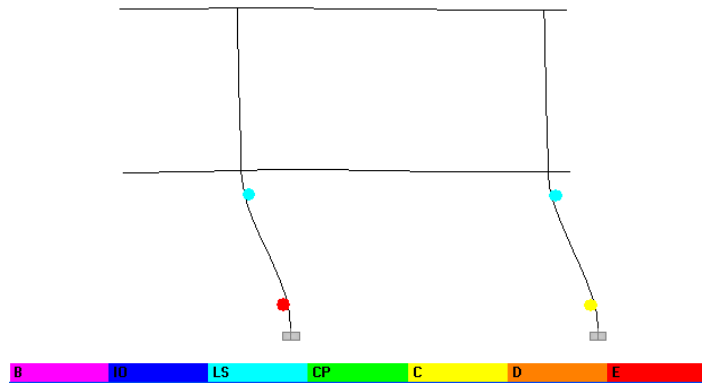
Plastification des poteaux avant les poutres – Typologie OBA0L.
